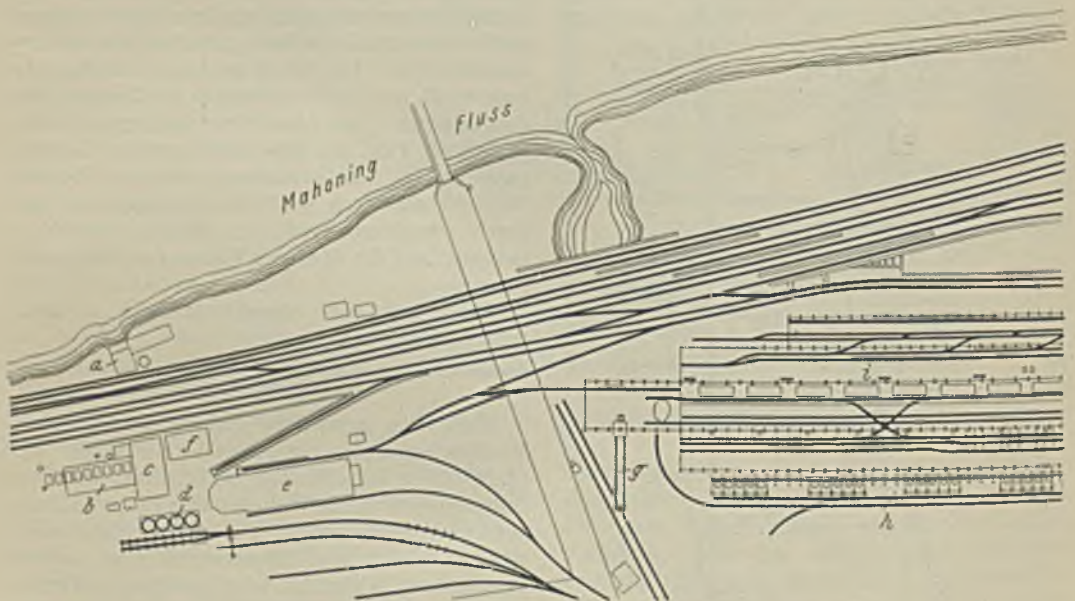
Lageplan der Brier Hill Steel Co. in Youngstown.
